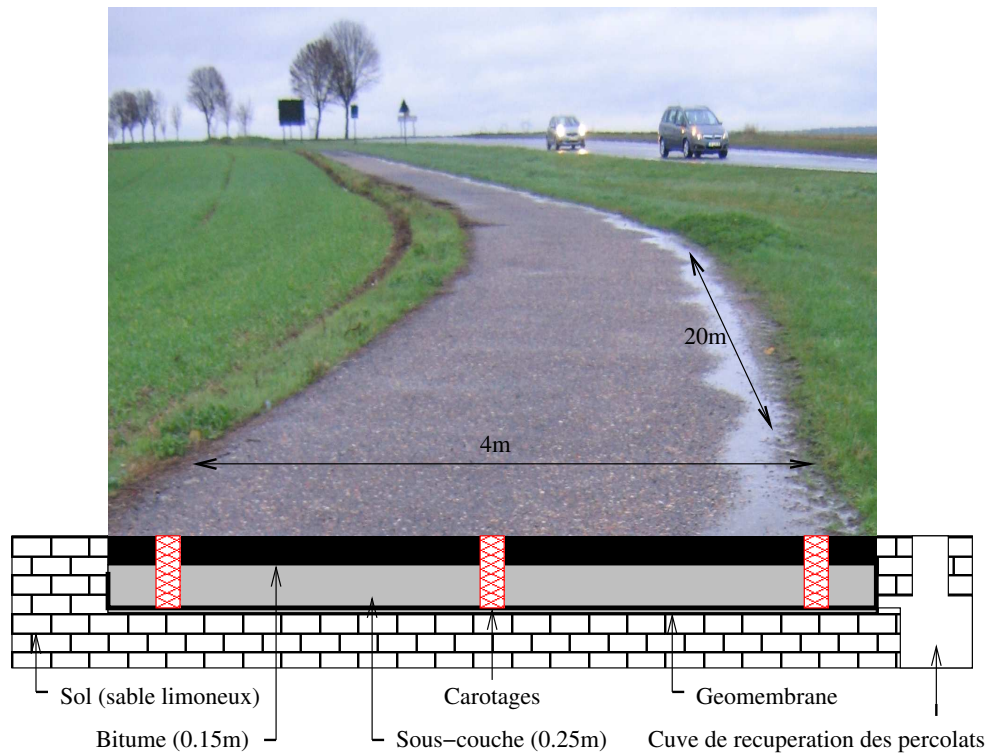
Photographie et schéma en coupe de la section de route instrumentée.
